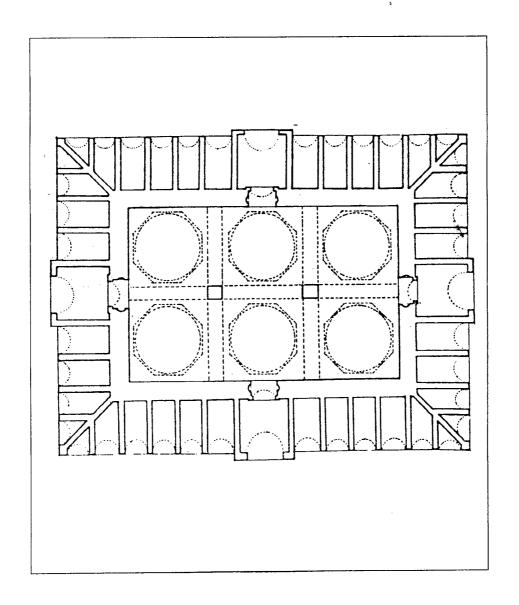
مسقط أفقي لصندل بادستان بإستانبول (عن :Cezar) .
